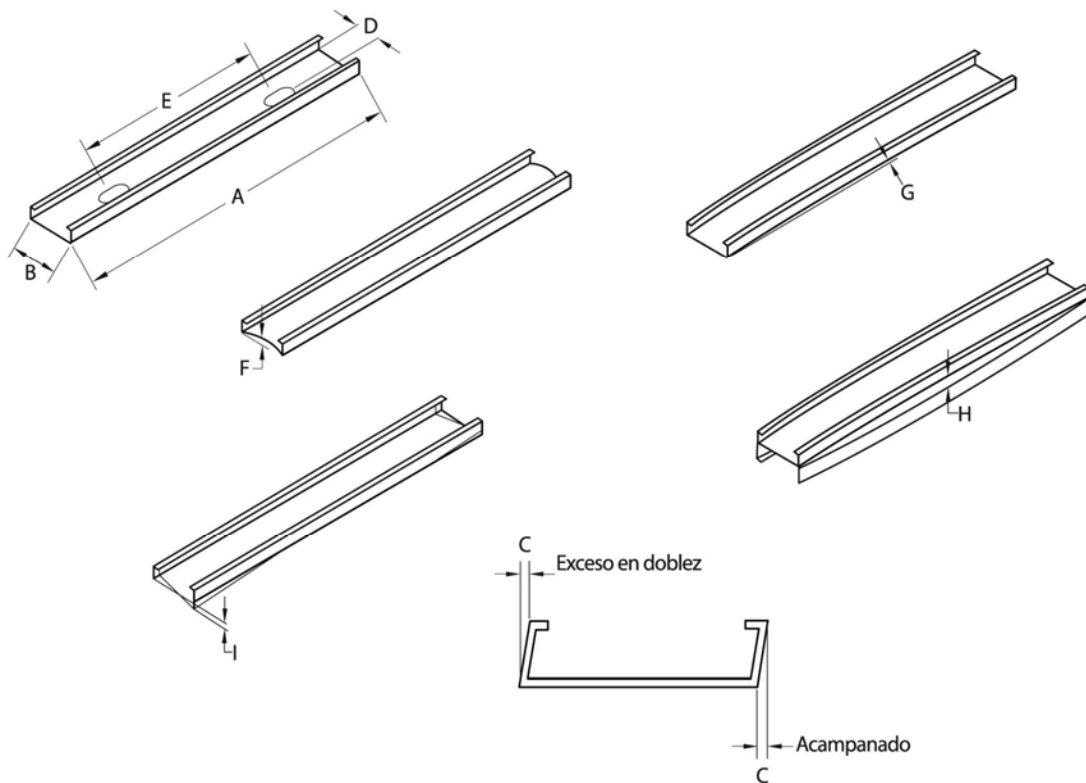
Tolerancias de fabricación para miembros no estructurales
